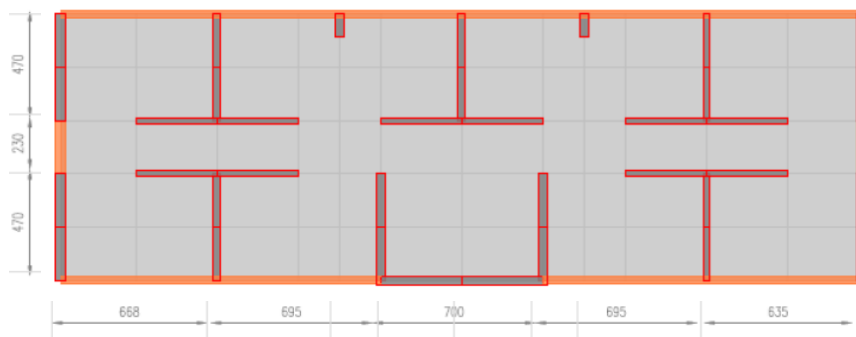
Planta estructural edificio de 15 y 20 pisos.
